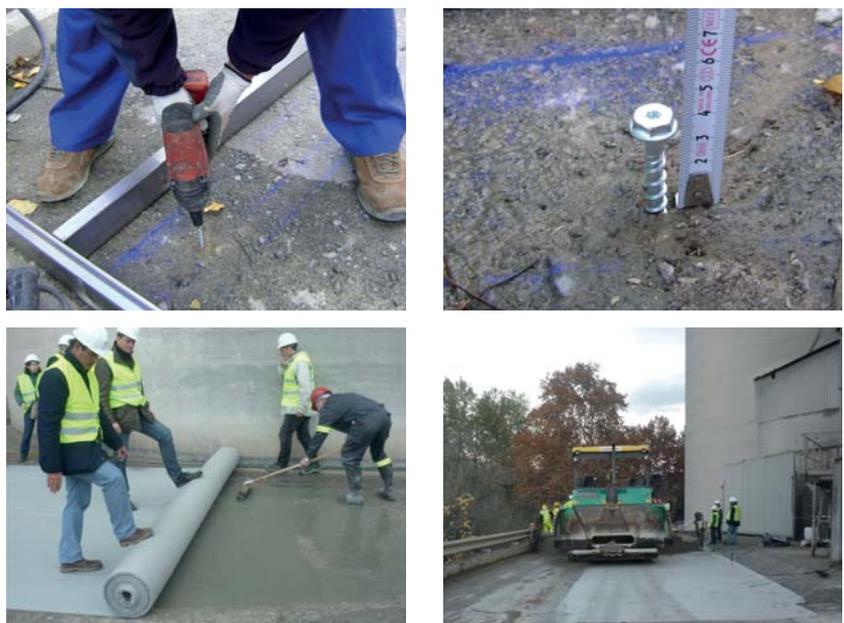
Colocación de anclaje mecánico stud (a) y aspecto final (b). Extensión del geotextil (c). Extendidora trabajando sobre el geotextil (d).
